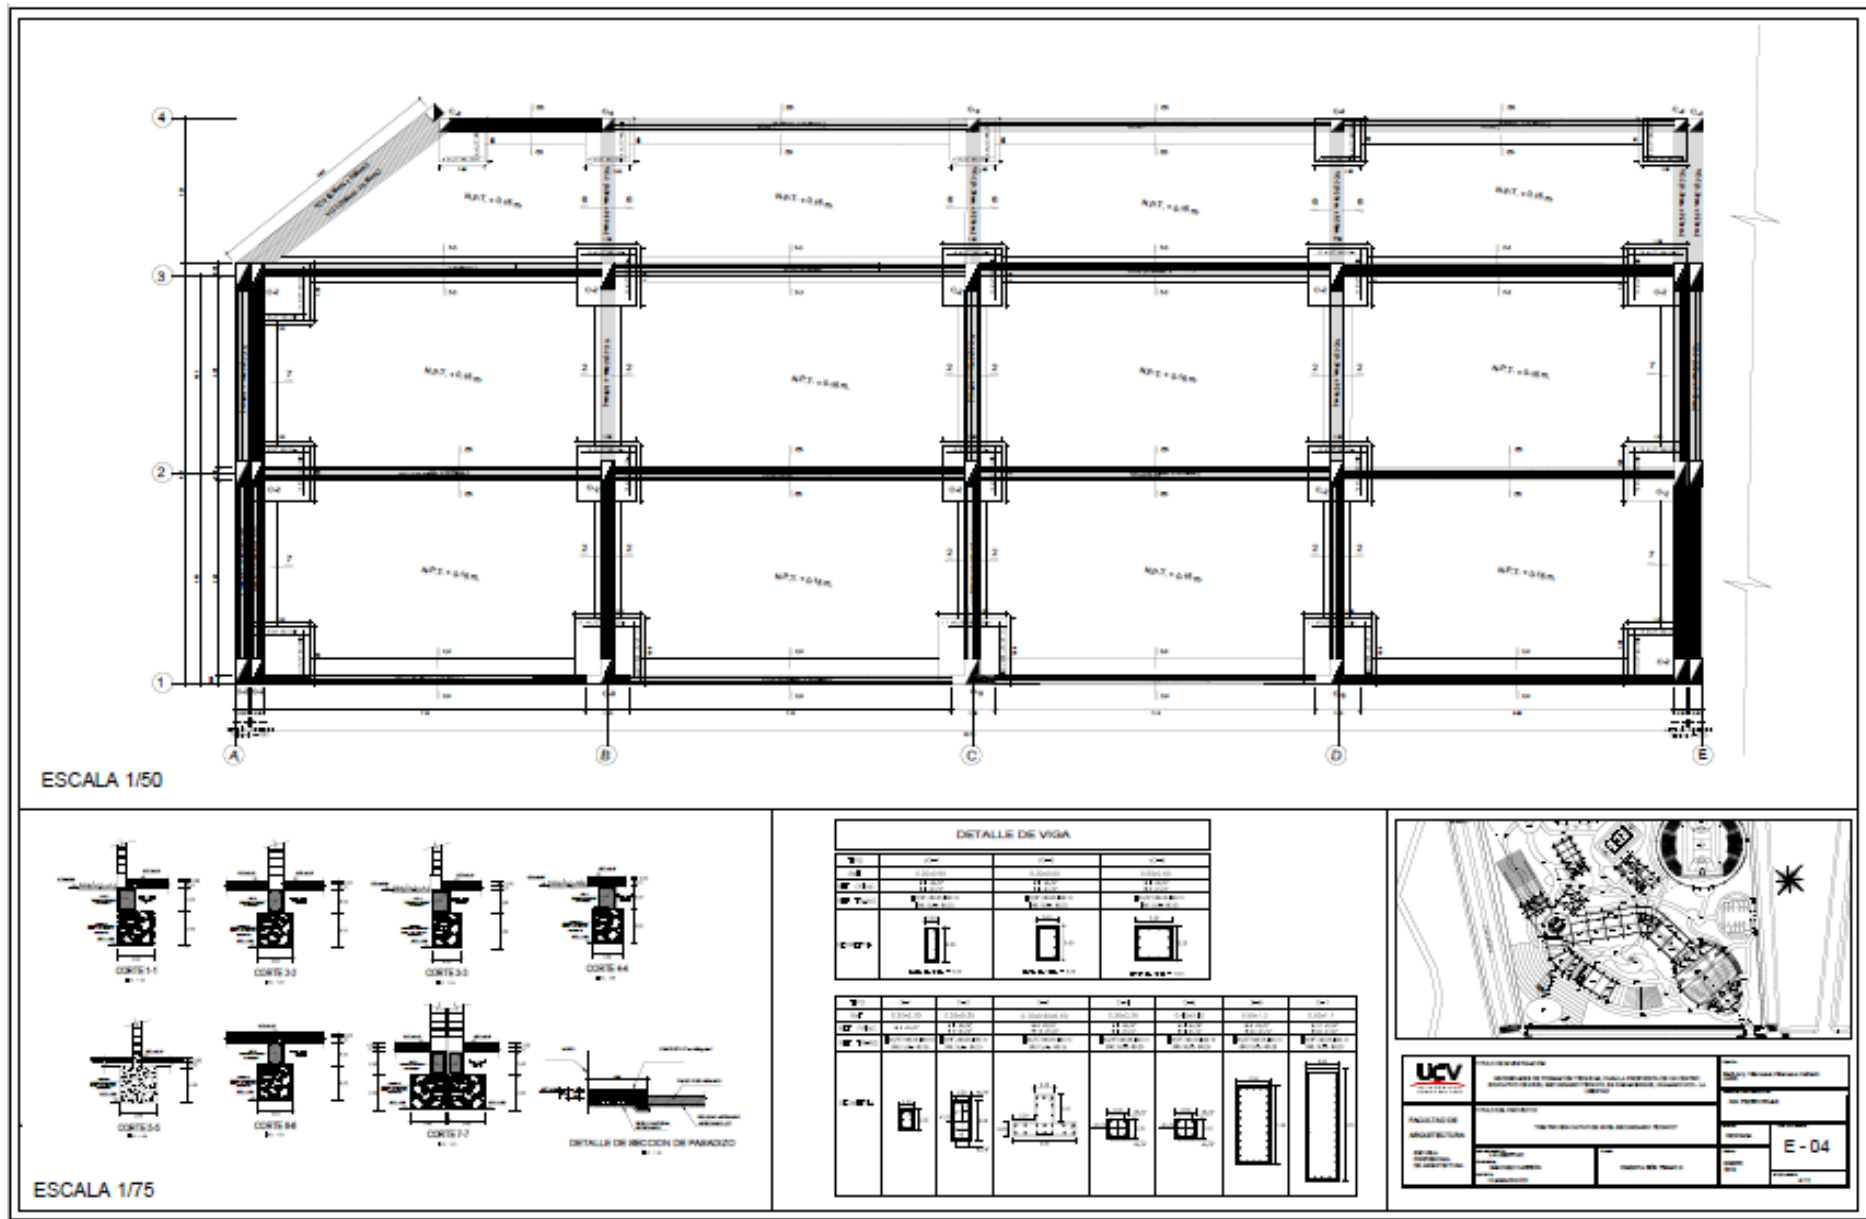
Plano Diseño Estructural Bloque 03 – Cimentación - Plano N° 12 - Lamina E-04
